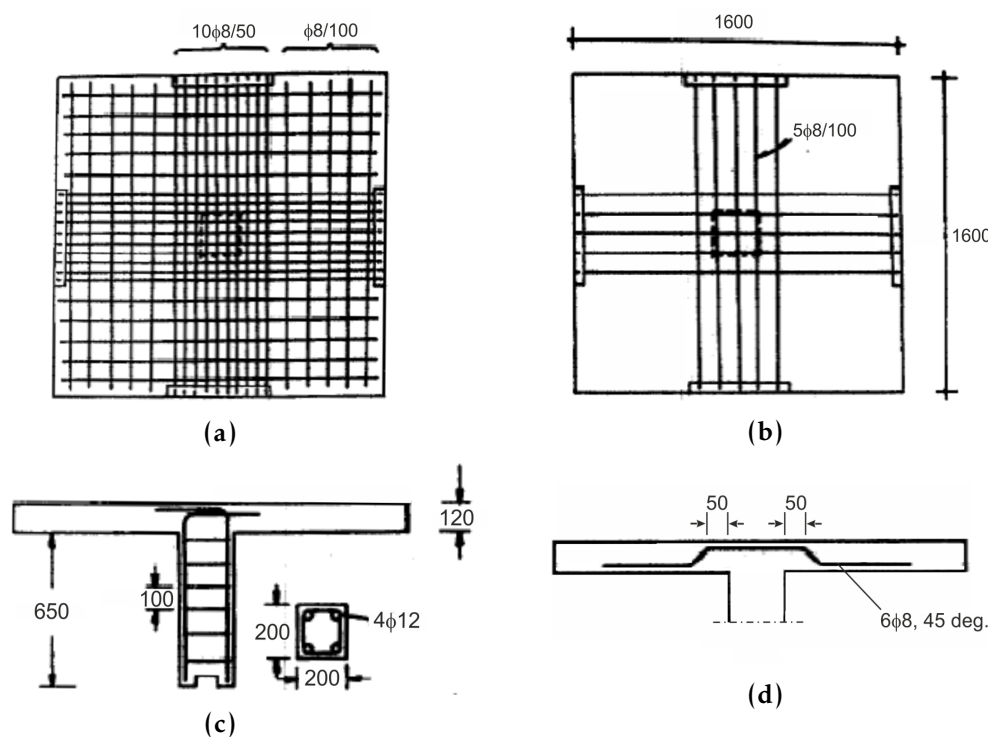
Geometria e características gerais dos modelos de Tegos e Tsonos [108] (dimensões em mm): (a) armadura superior, (b) armadura inferior, (c) detalhes das armaduras do pilar e (d) armadura de punçoamento do modelo S1.
